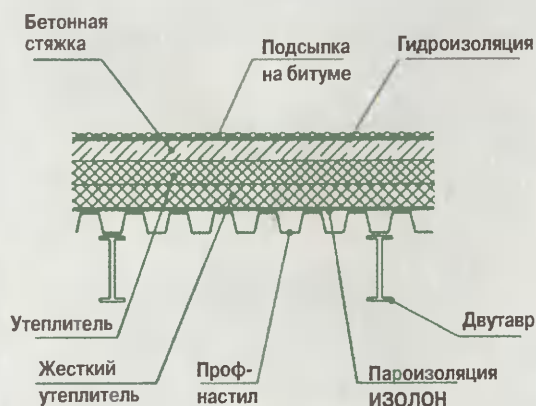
Защита мансарды и кровли ИЗОЛОН марки ППЭ 3002-3010)
